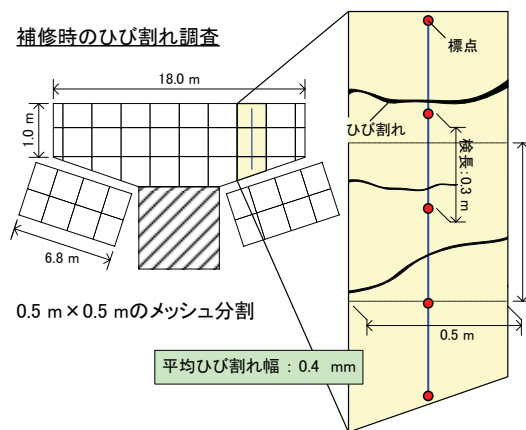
ひび割れ幅による測線の膨張量算出手法
